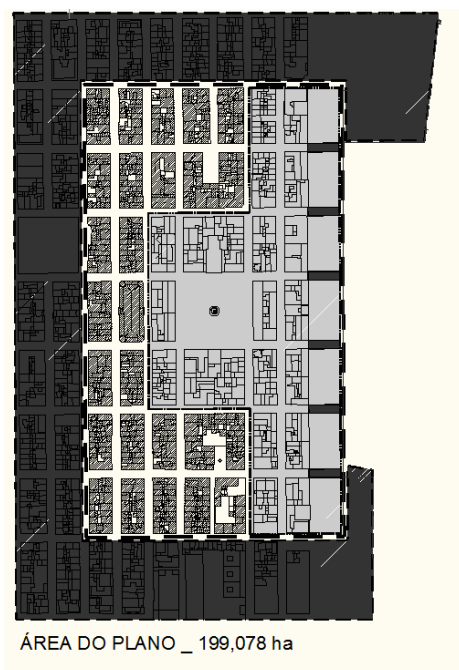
Planta de Implantação do PPS.NP.VRSA – Área de intervenção 199,078ha
